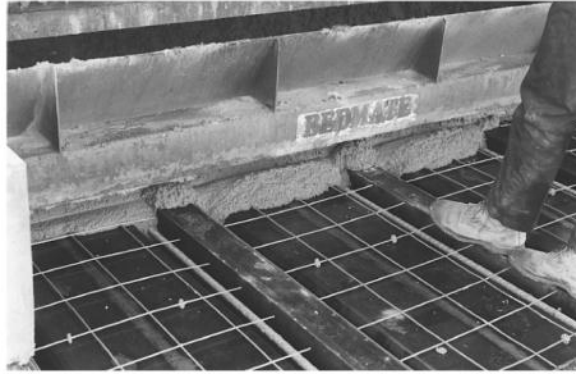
Construção de lajes pré-moldadas, Atlanta, Geórgia (ACI 440R, 1996).
